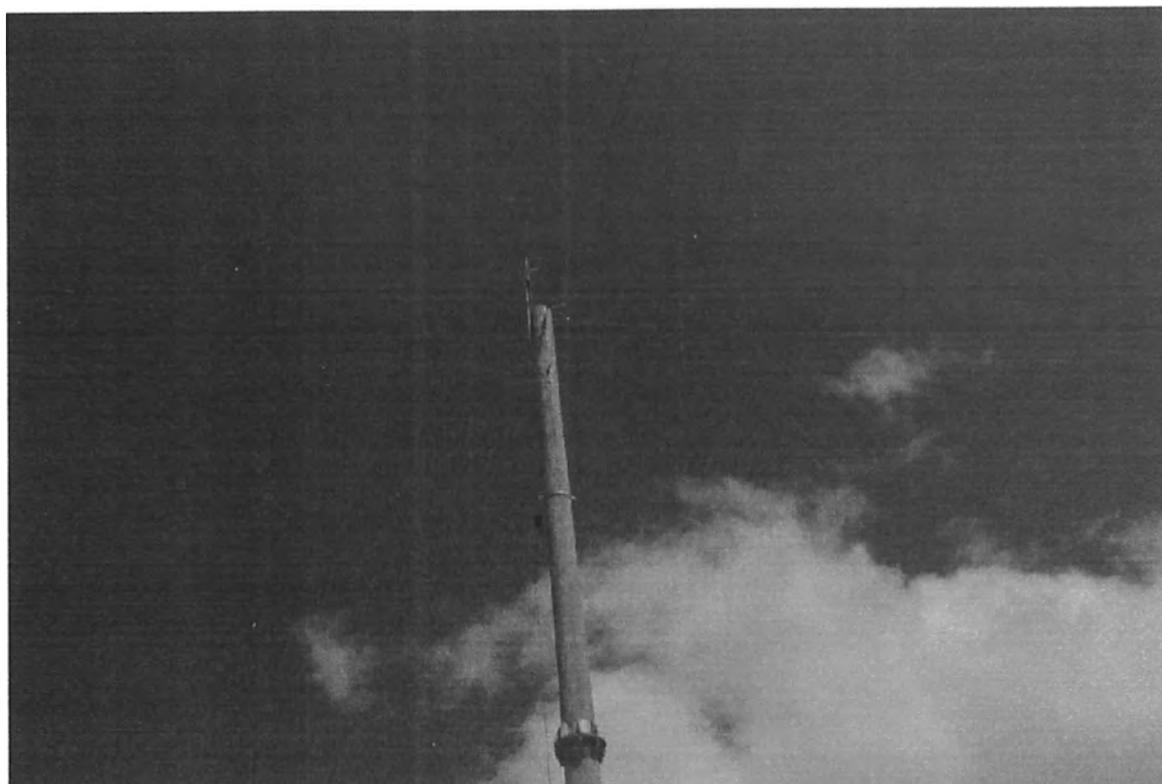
Vista del Poste P 22, altura 18m, Poste seccionables en dos secciones
